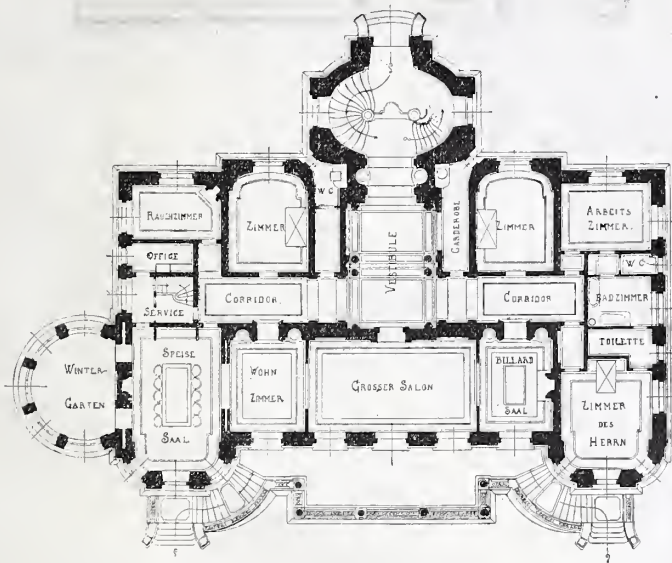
Grundriss vom Erdgeschoss.
